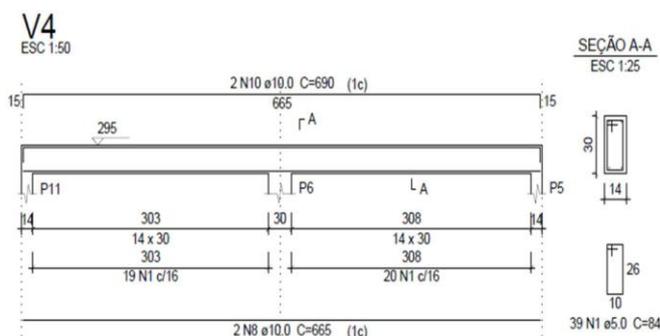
Seção das vigas de respaldo e detalhes da armadura long/trans
